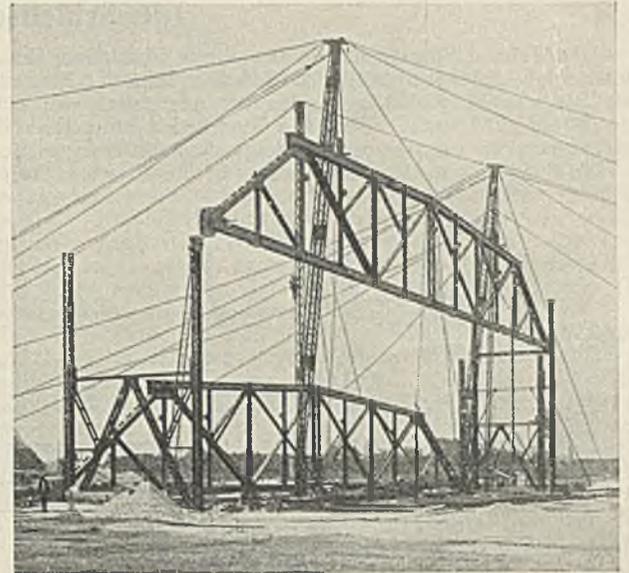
Hochziehen des ersten 60 m breiten Hauptbinders.
